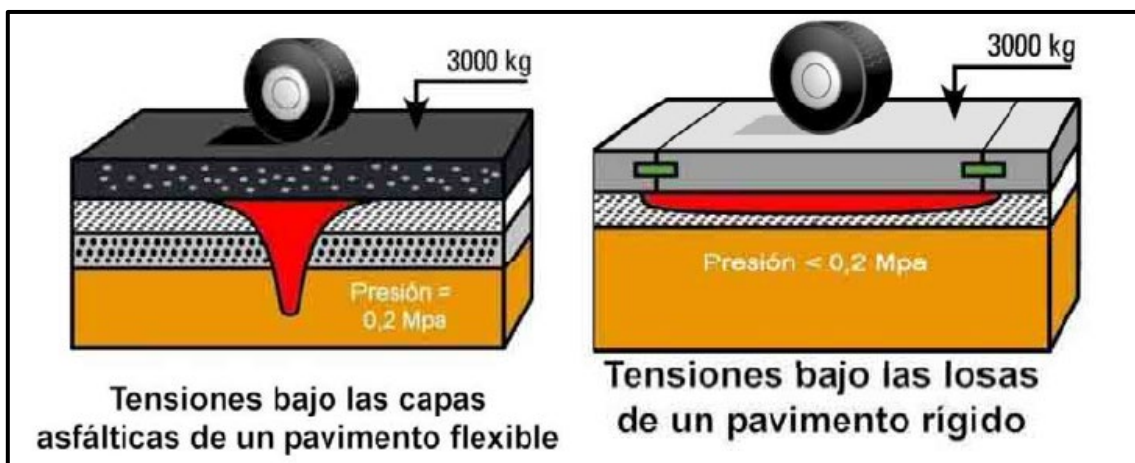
Distribución de tensiones en pavimentos flexibles y rígidos
